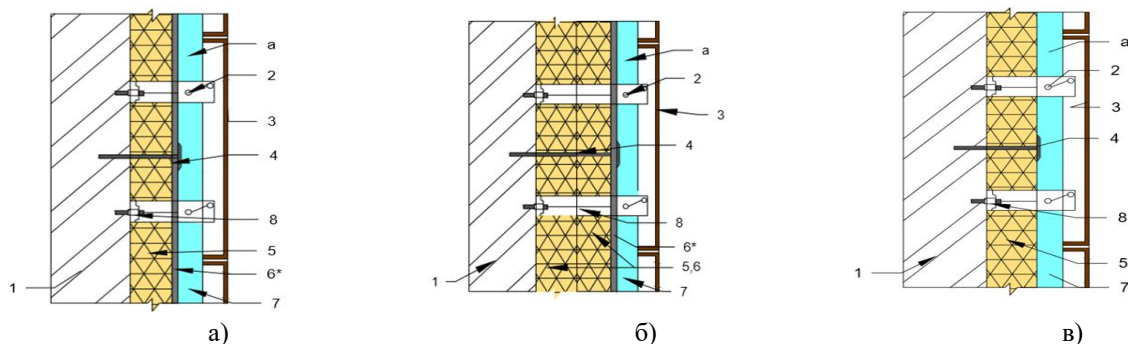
Конструктивно-технологічні схеми навісного вентиляльованого фасаду:
